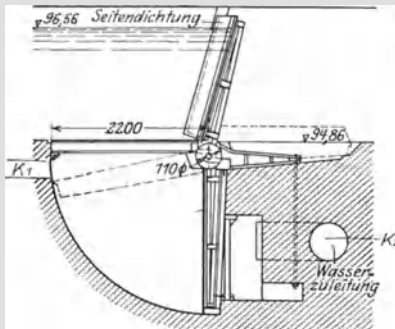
Trommelwehr der Staufstufe Kesselstadt.
